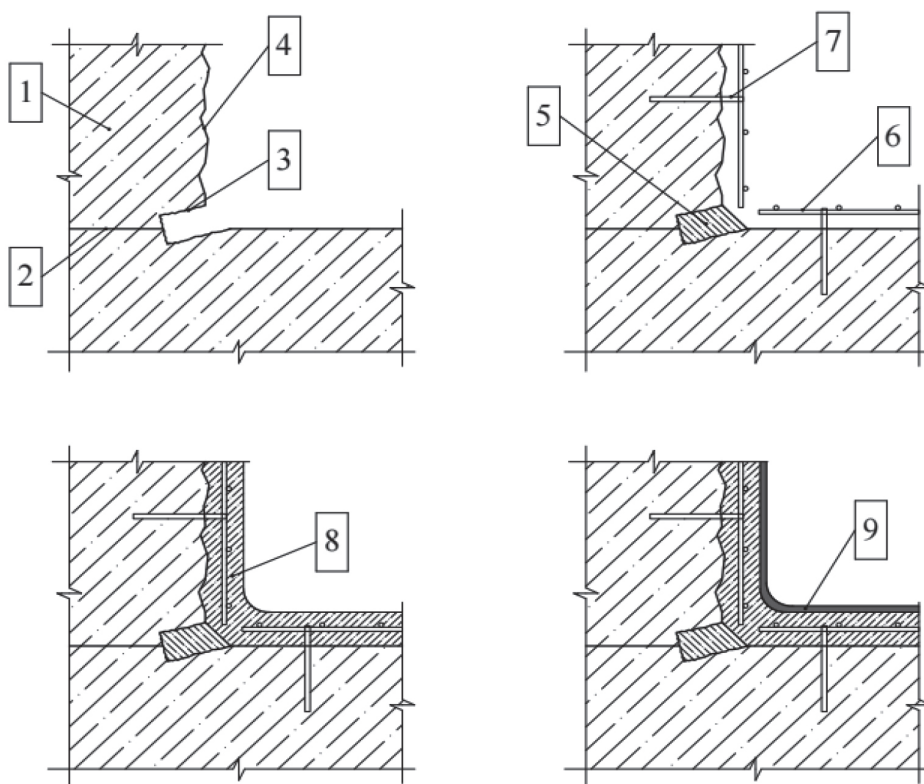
Гидроизоляция и облицовка бассейна
